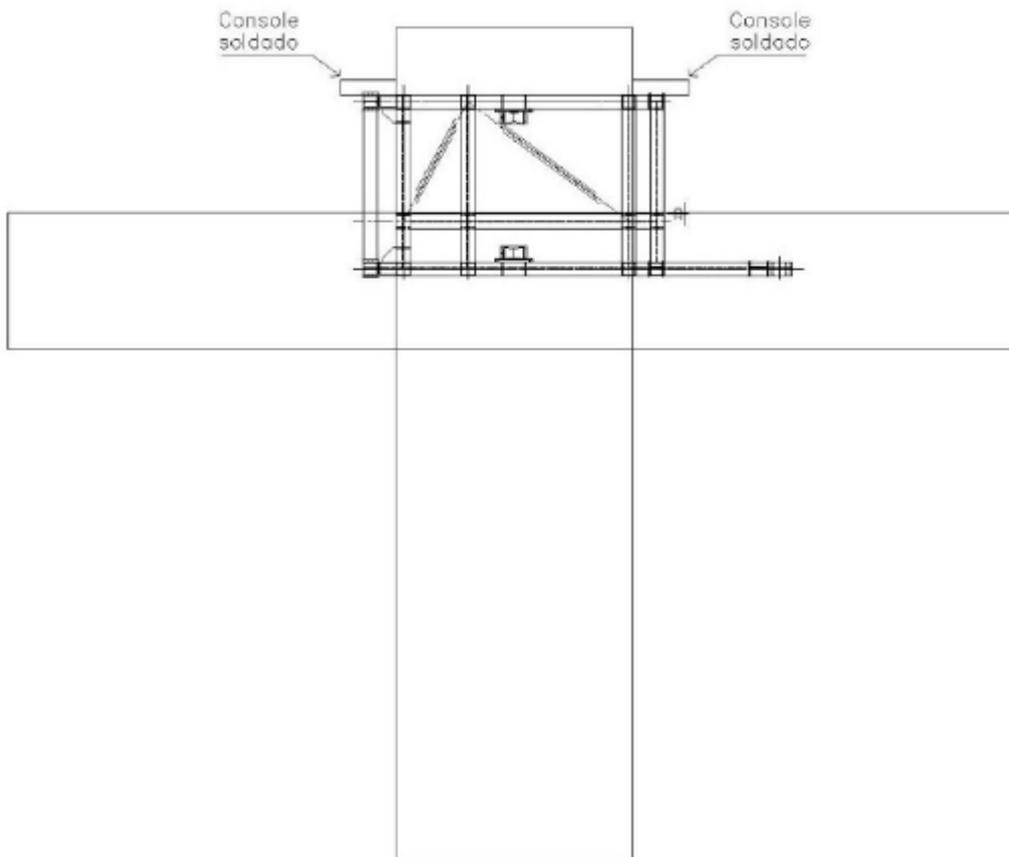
Planta dos posicionamentos do tubo e do guindaste no plano de içamento
